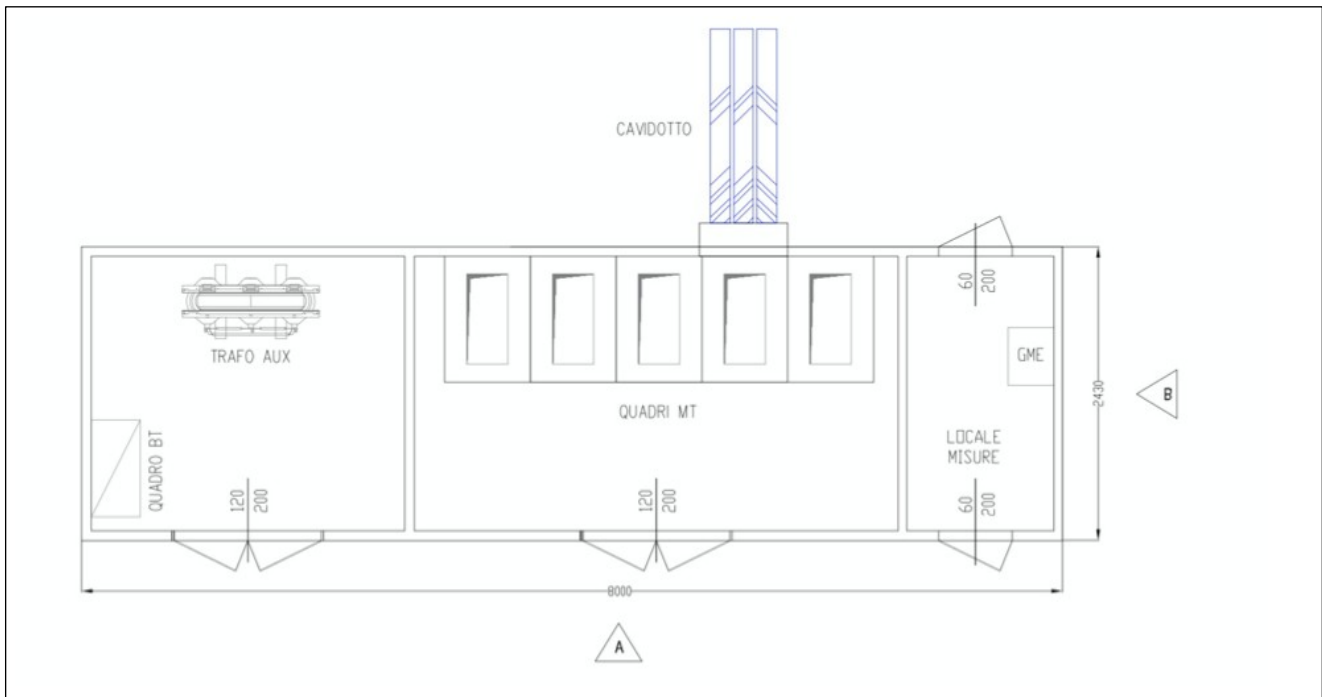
Locale cabina di Parallelo MT-Prospetto
